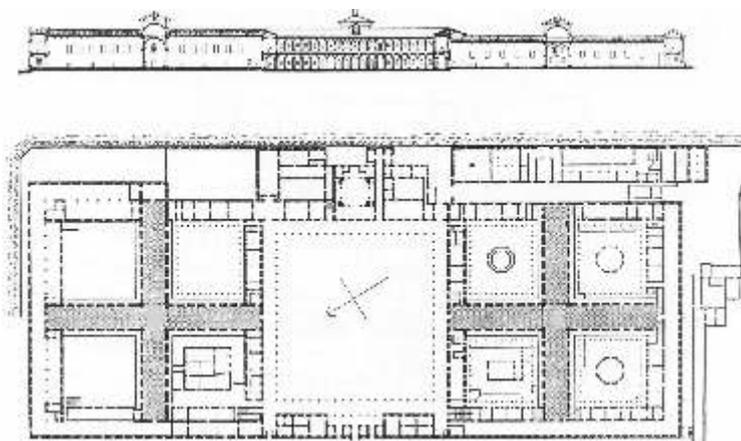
Elevação e planta do Ospedale Maggiori di Millano. Fonte: LEISTIKOW,1967.
